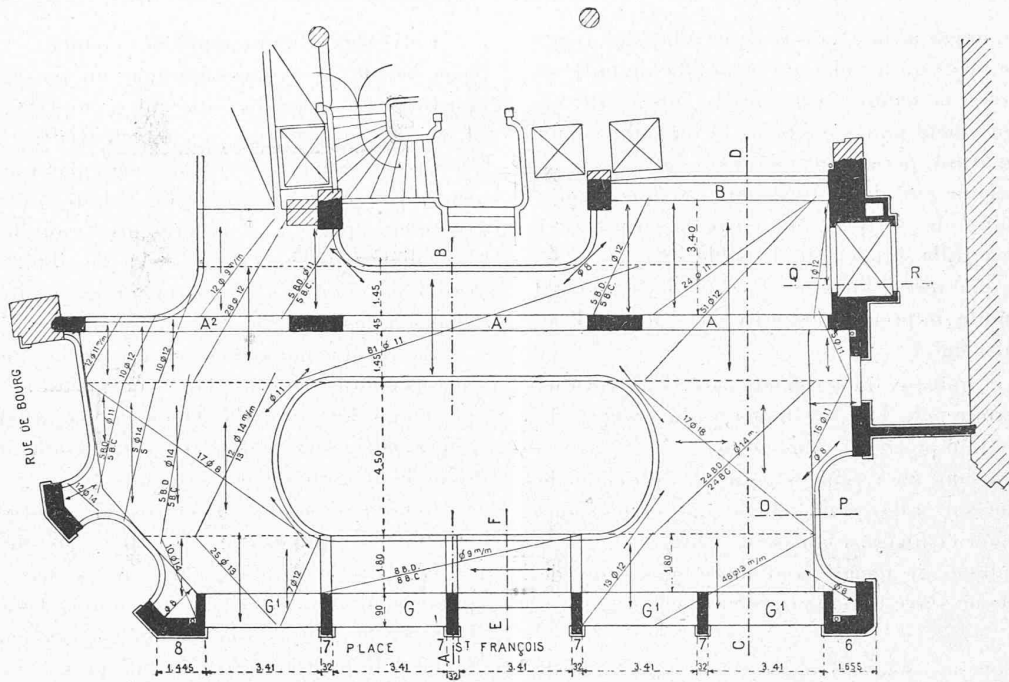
Rez-de-chaussée. — 1 : 200.
